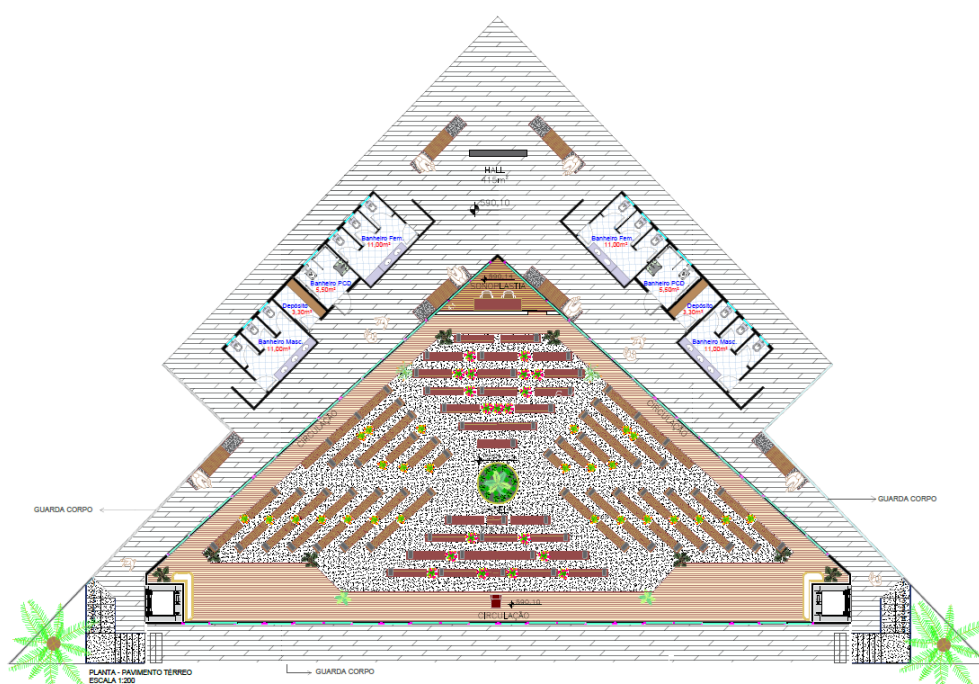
PLANTA BAIXA – PAVIMENTO TÉRREO - Elaborado pelo autor.
